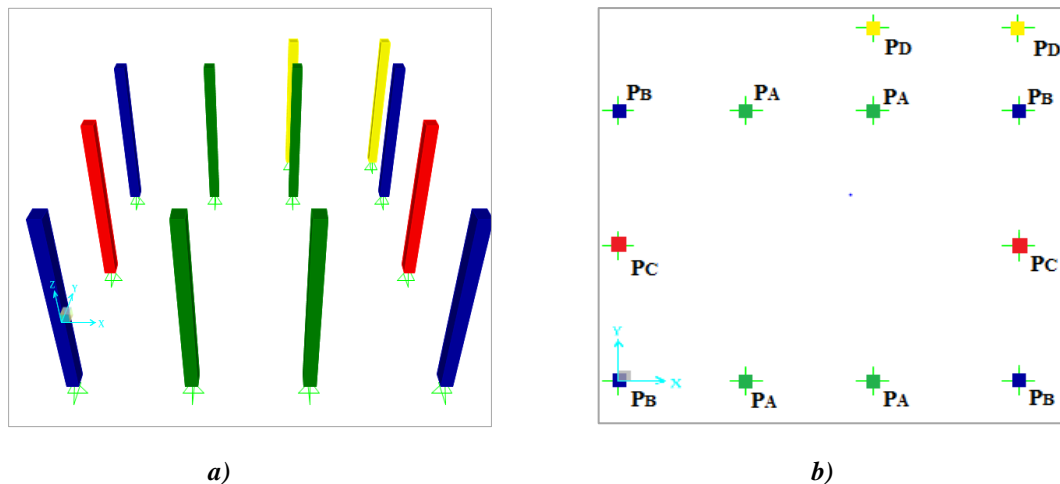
Identificação dos Grupos de Pilares – a) Vista em 3D; b) Vista em Planta
